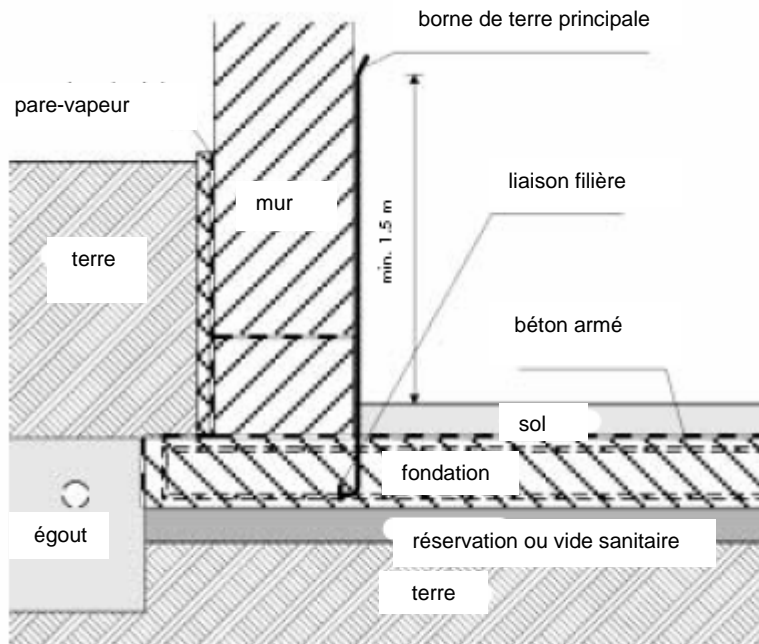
Illustration du positionnement d'une électrode de terre de fondation dans des fondations en béton armé
